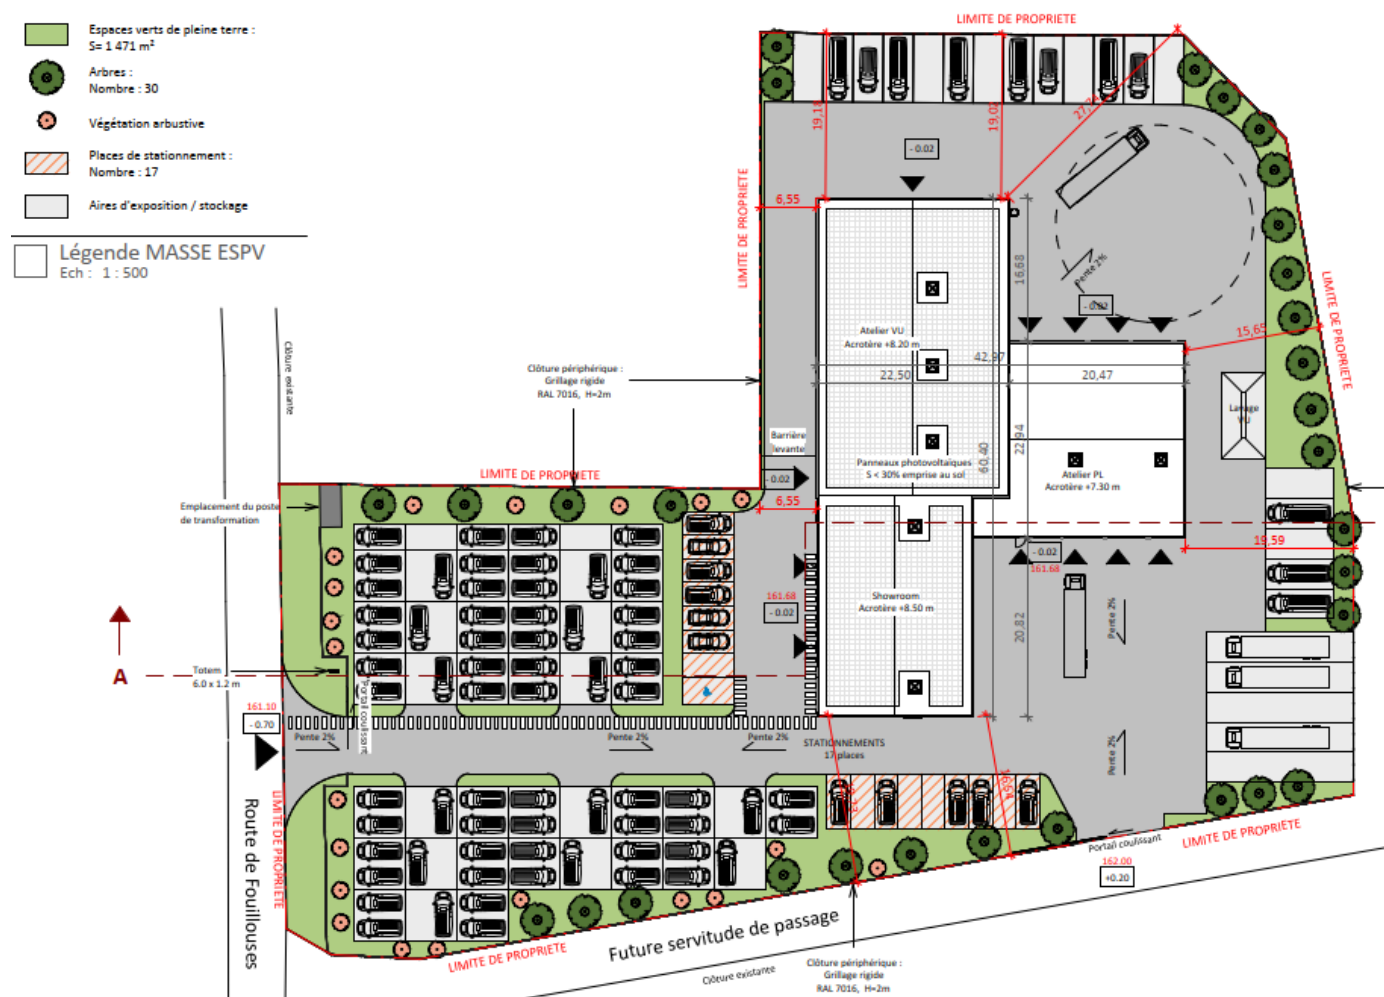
Plan masse de l'état projeté (Source : dossier de permis de construire)
